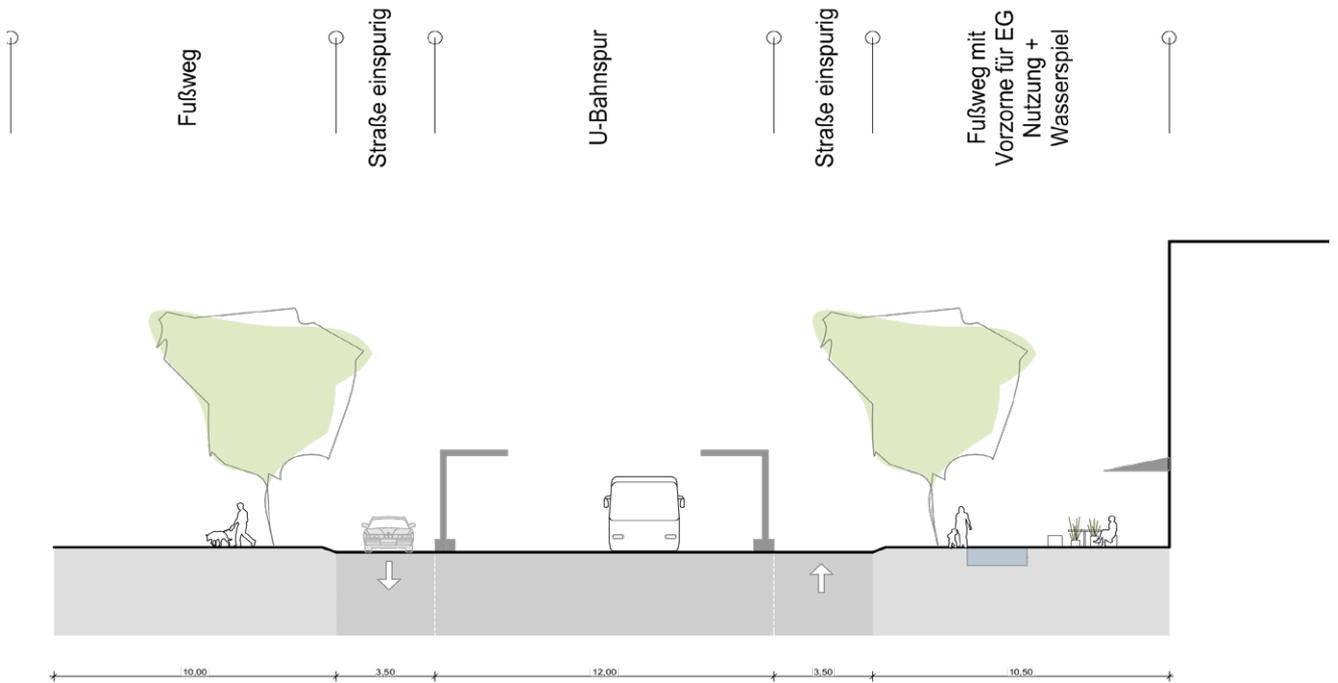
Wasenstraße Umgestaltung Schnitt (Eigene Darstellung)
